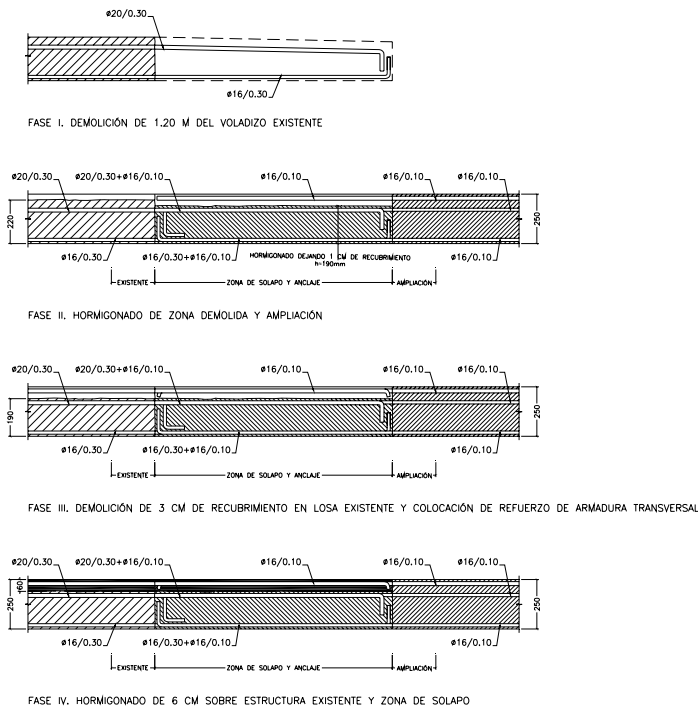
Fases de construcción de la conexión entre la losa existente y la losa del voladizo ampliado.
